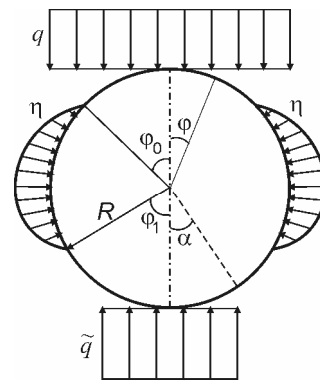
Схема розподілу навантаження на трубопровід (поперечний переріз)
